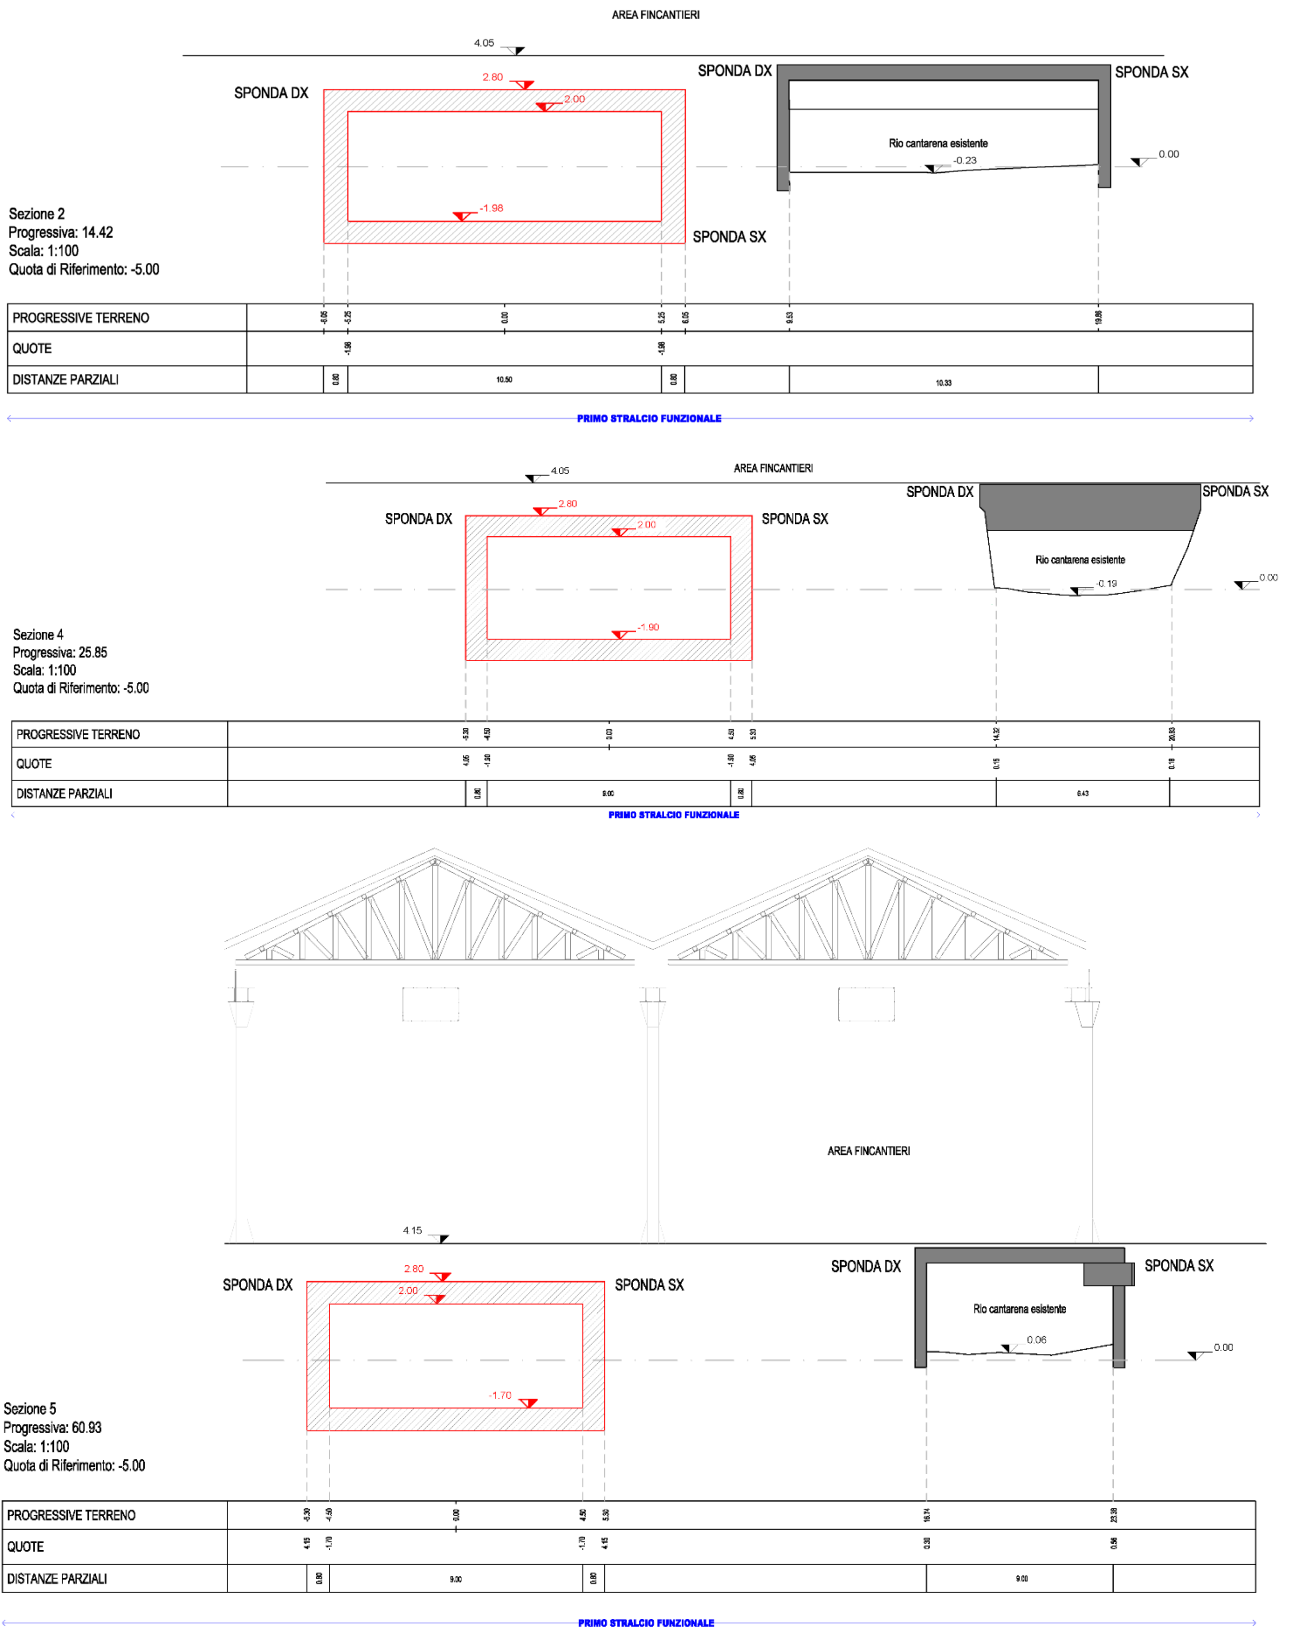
Sezione 2, 4 e 5 della situazione attuale (grigio) e di progetto (rosso) del rio Cantarena.
